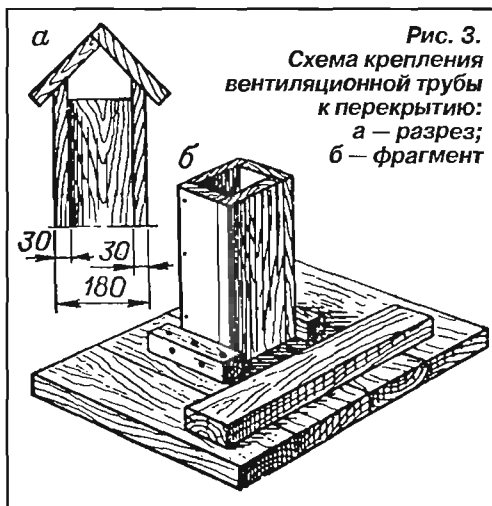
Схема крепления вентиляционной трубы к перекрытию: а — разрез; б — фрагмент
